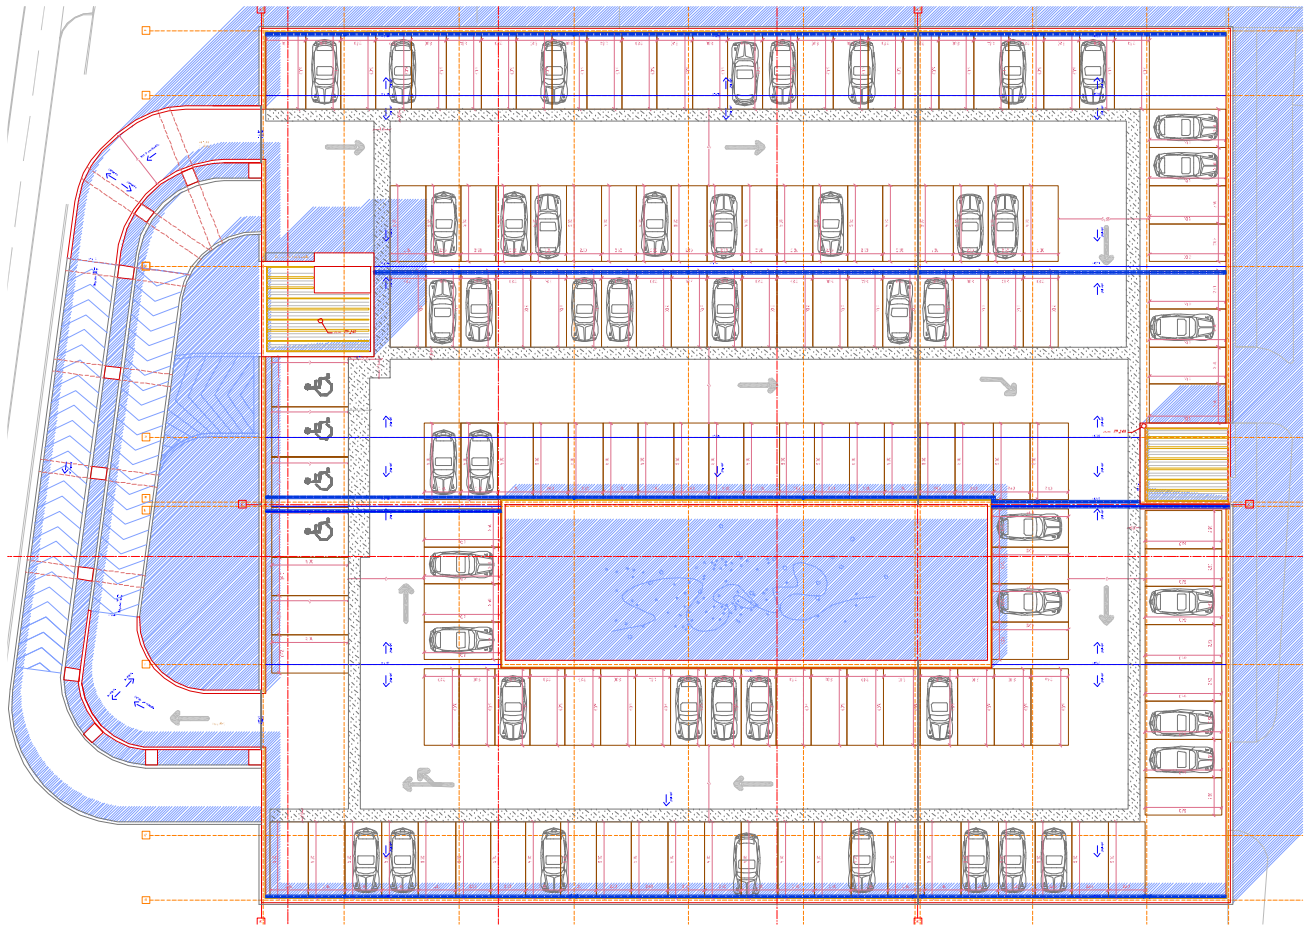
Vue en plan de la toiture du parking P+R de Villenave d'Ornon
